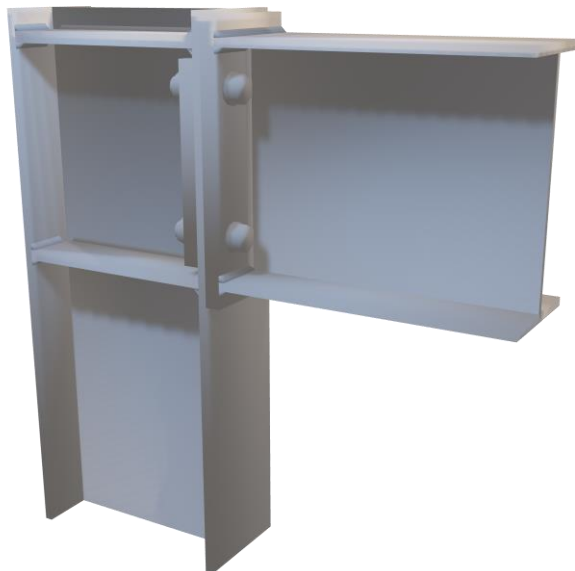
Vista isométrica de la unión de IPE300 sin cartela
